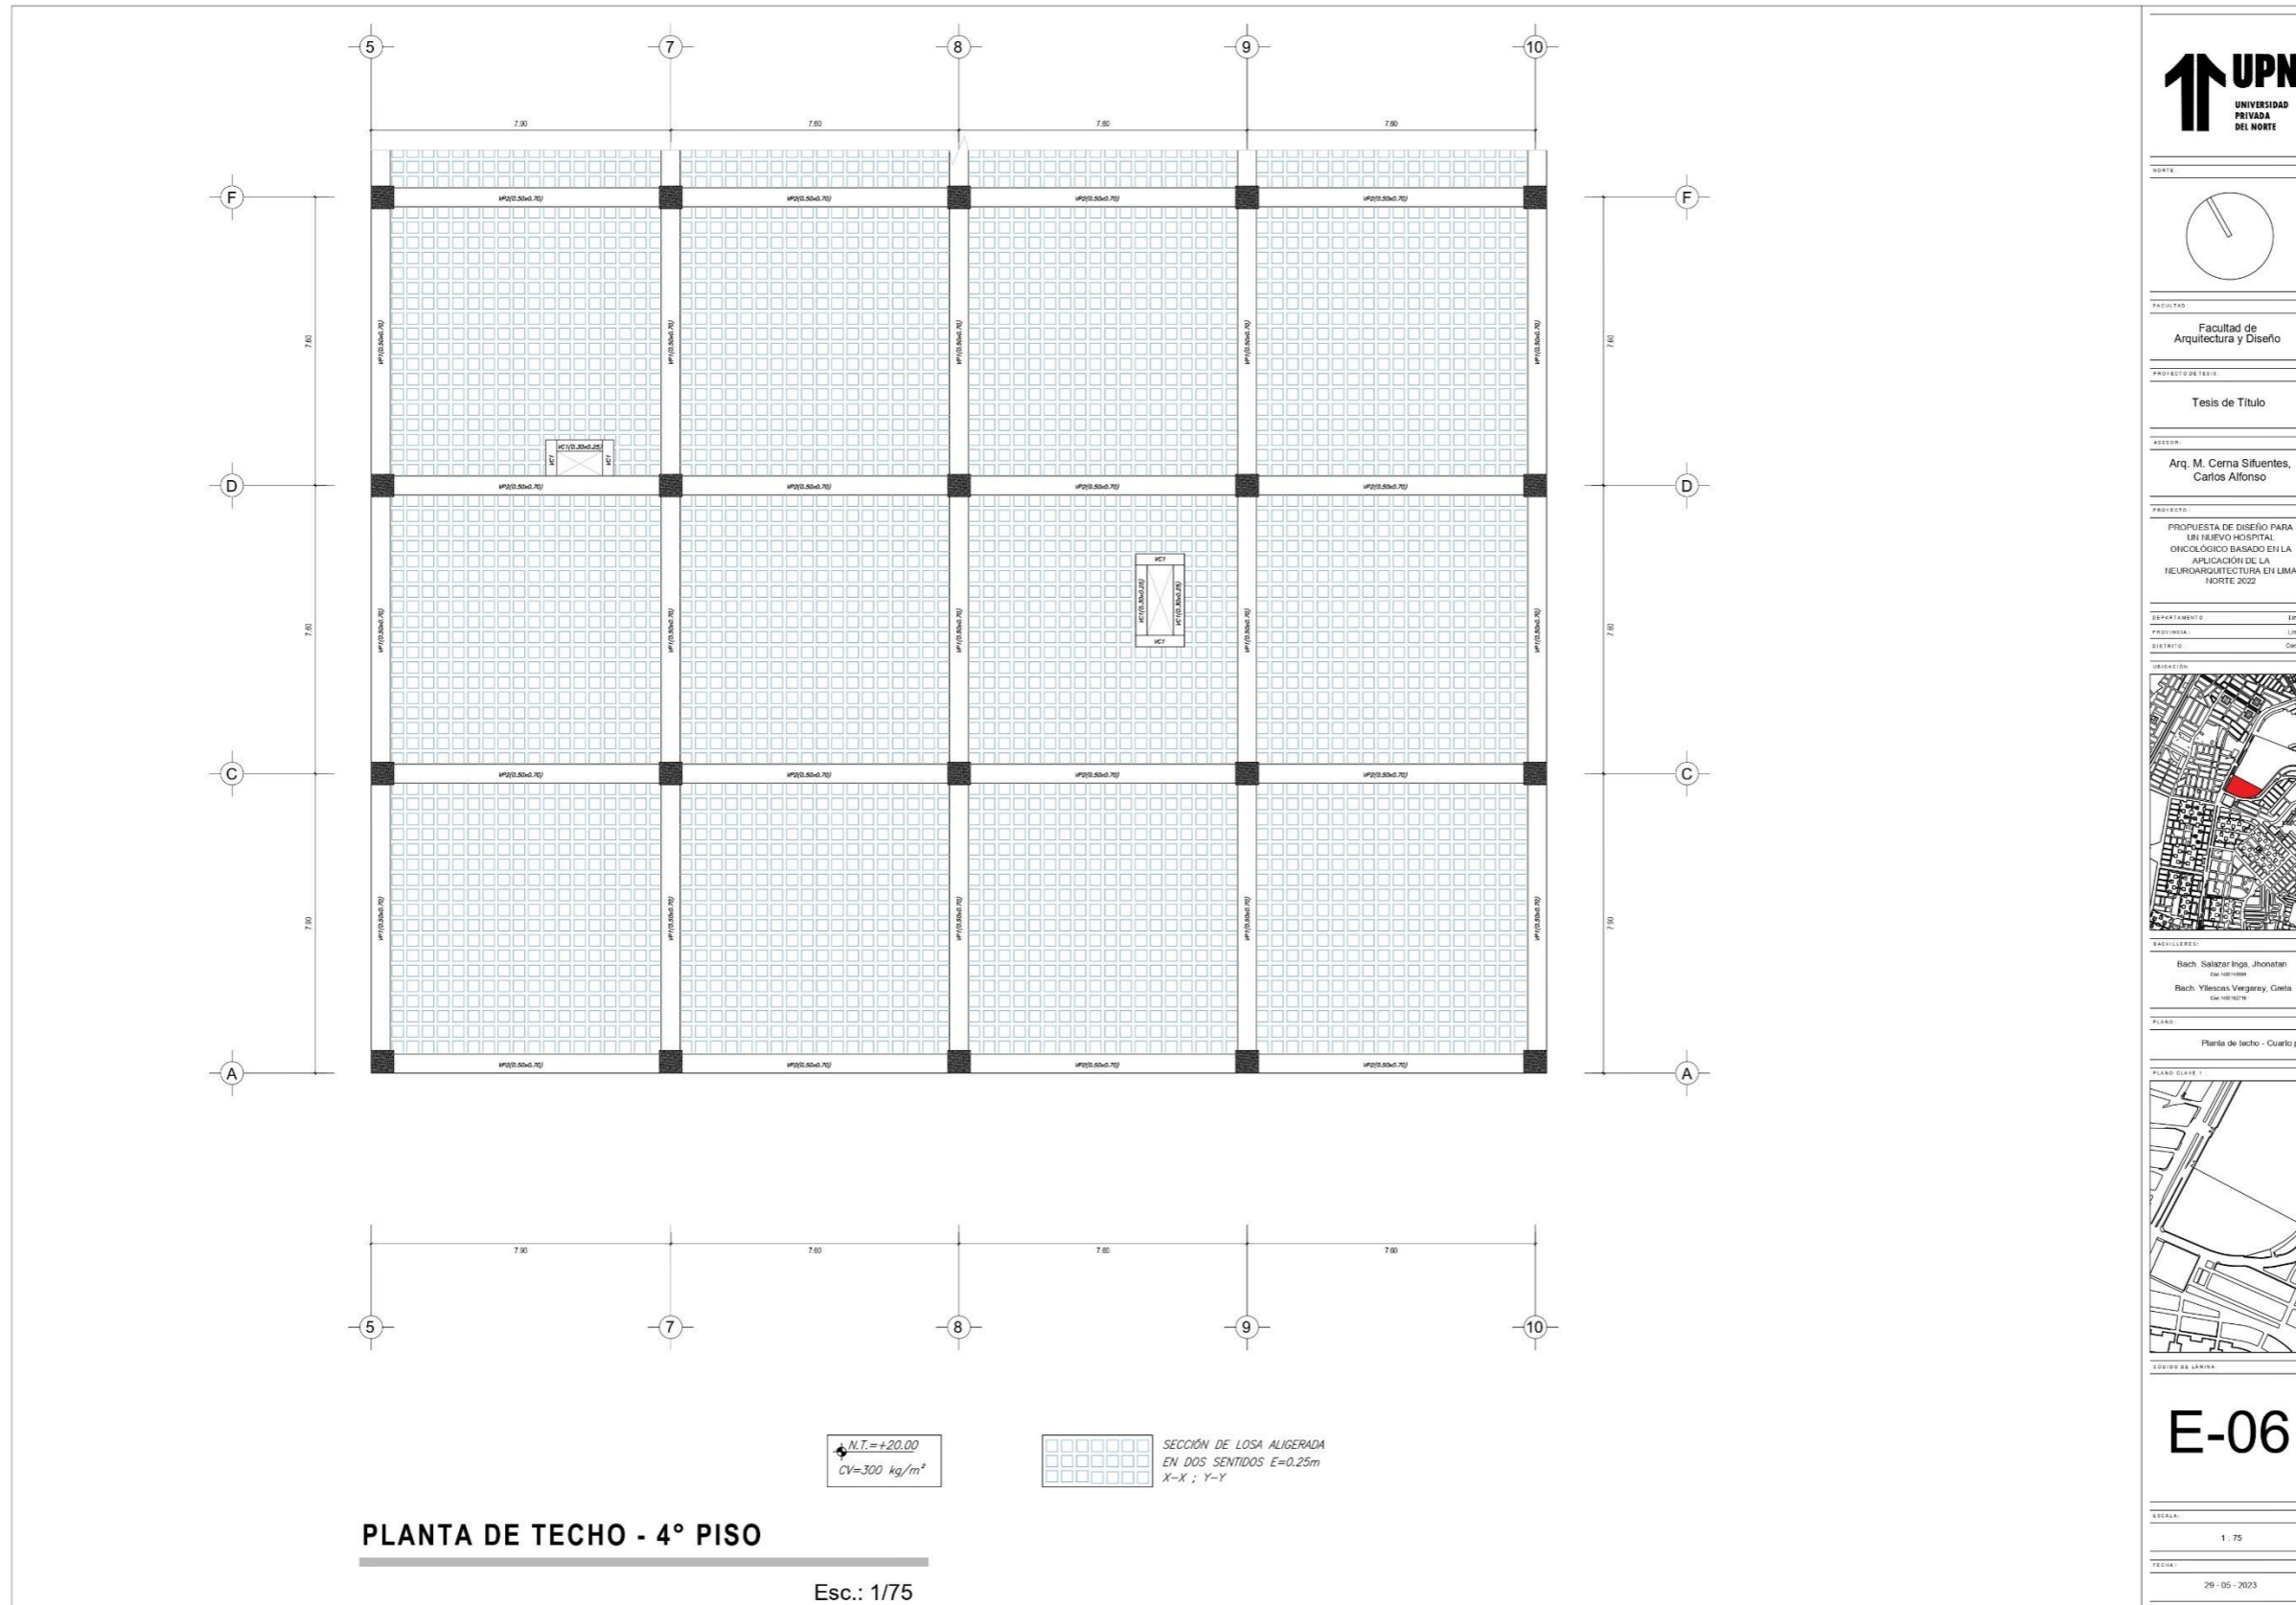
Estructuras – Aligerado planta de techo N°4 piso del sector cuadrante Esc: 1/75 (Fuente: Elaboración propia de los coautores)
